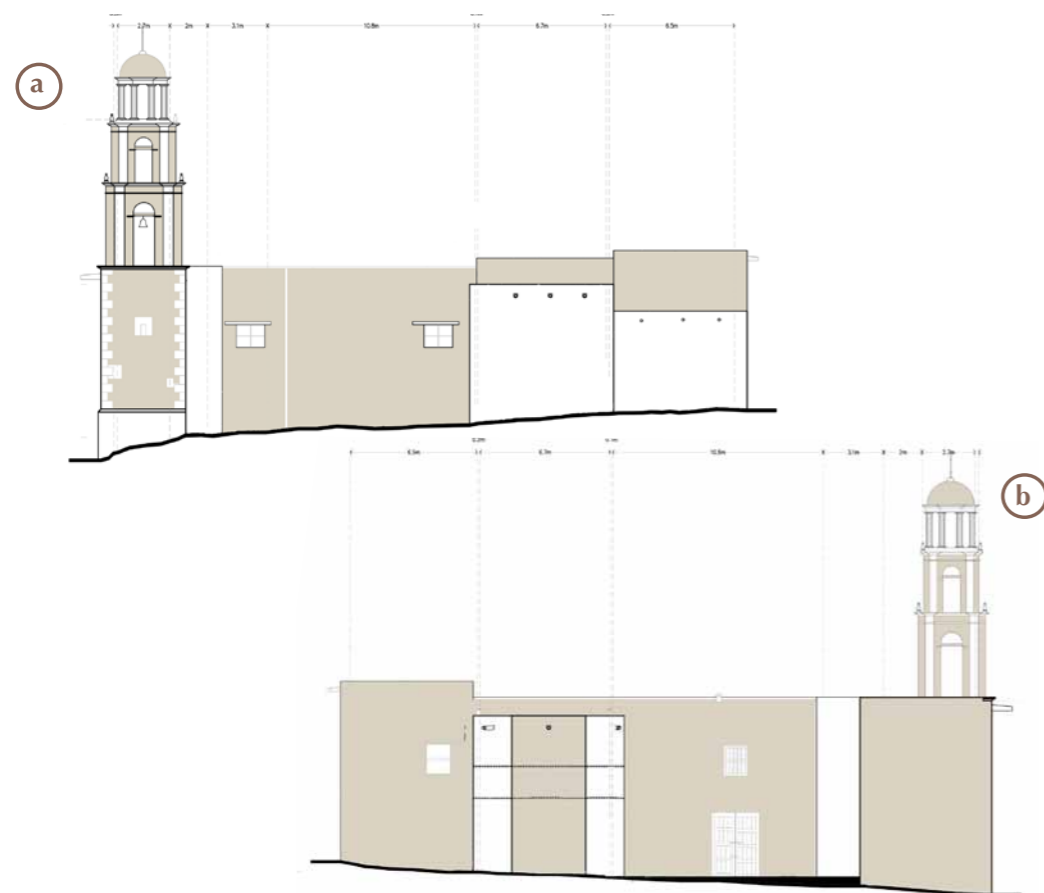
22. Alzados arquitectónicos del templo de Santa Rosa de Lima. Corte fachada Norte (a); corte fachada Sur (b). (Dibujos: Misiones Coloniales de Chihuahua A.C, 2011).
